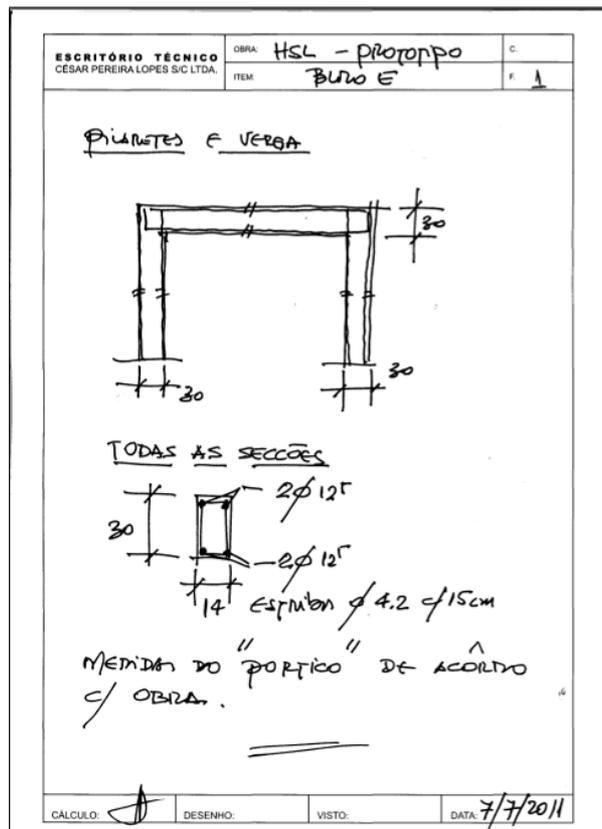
Croqui dos pilaretes e da verga para execução em alvenaria
